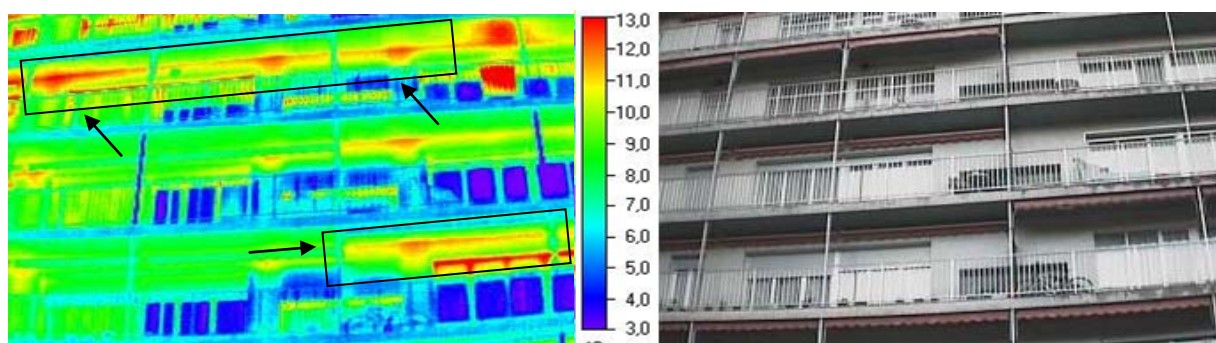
Cerramientos exteriores. Detalles ventanas aluminio
